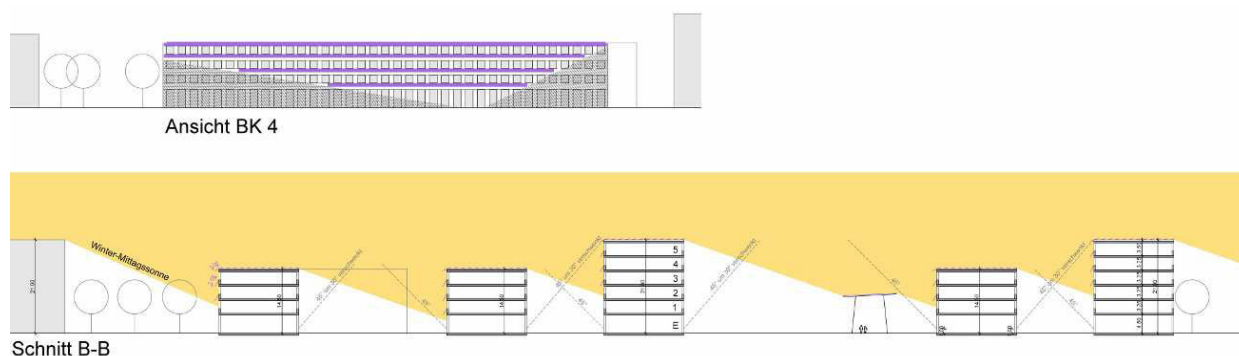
Büro: Schnitt, Fassadenansicht mit Eigenbeschattung
